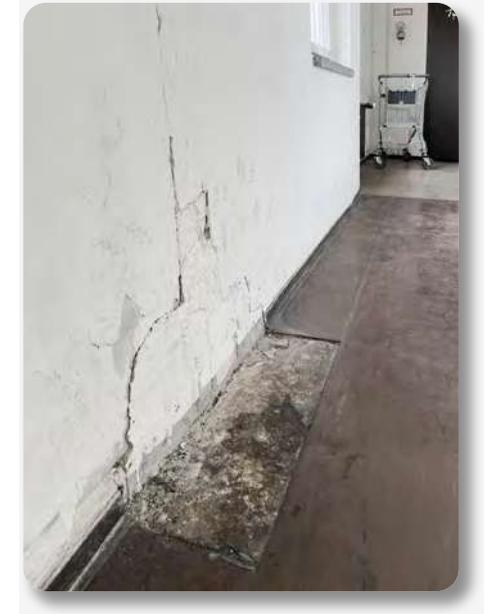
Konservierung & Instandhaltung der Hauptfassade
